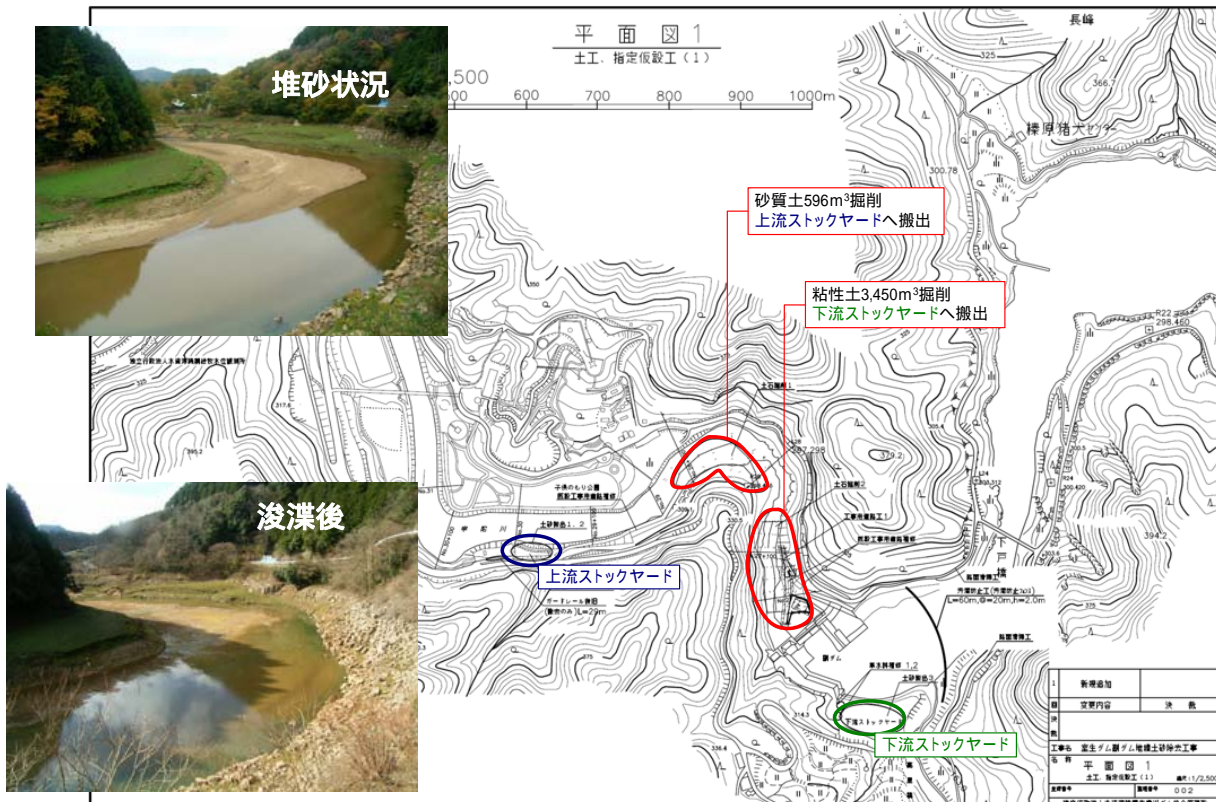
2008(平成 20)年度浚渫工事箇所平面図
